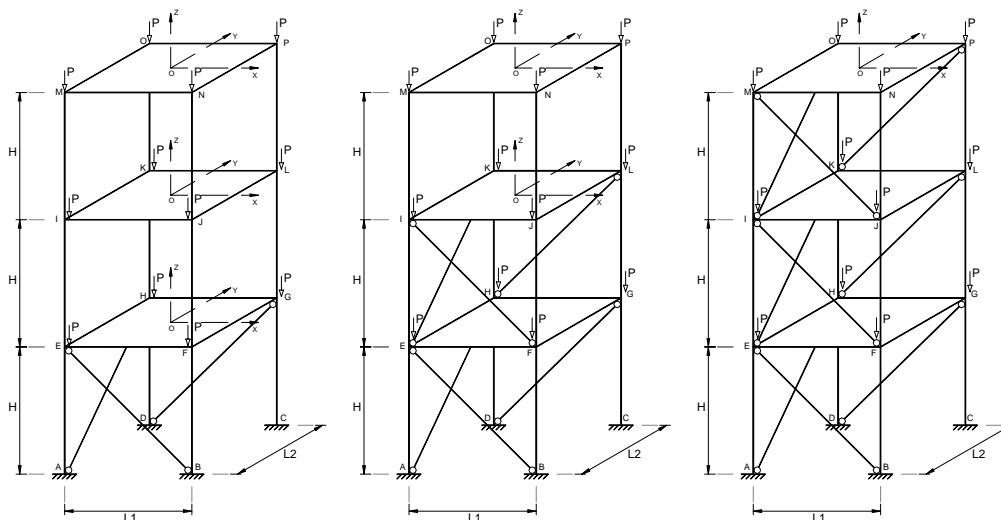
Pórtico 3D contraventado em altura (pisos: 1; 1-2; 1-2-3) em 3 planos
